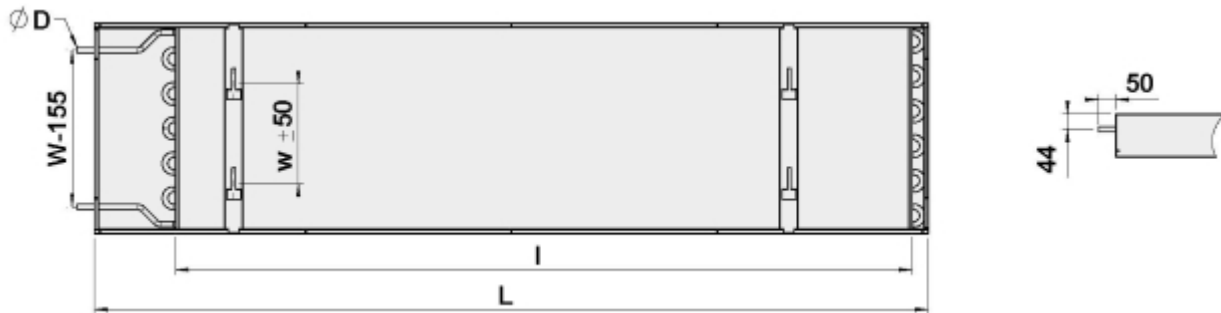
Halton Rex REP, dimensions avec emplacement du tuyau à l'avant ($WD = F$)
